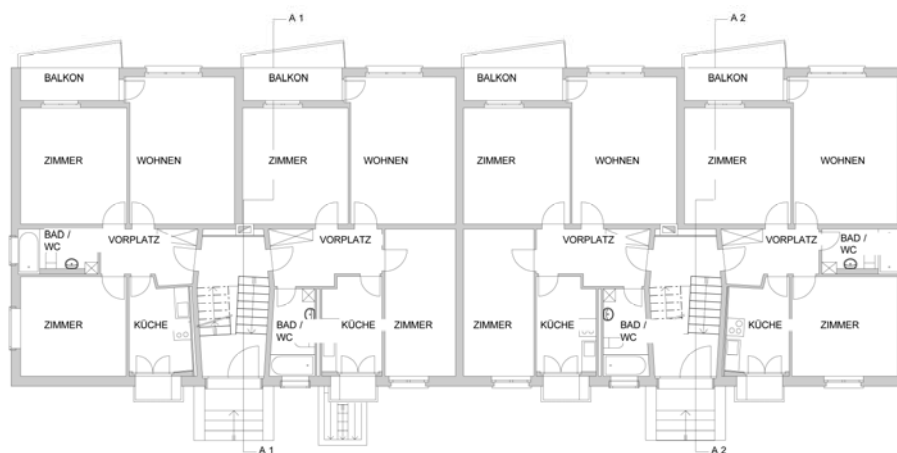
Grundriss Regelgeschoss, MFH Weinberglistrasse 62/64, Luzern
